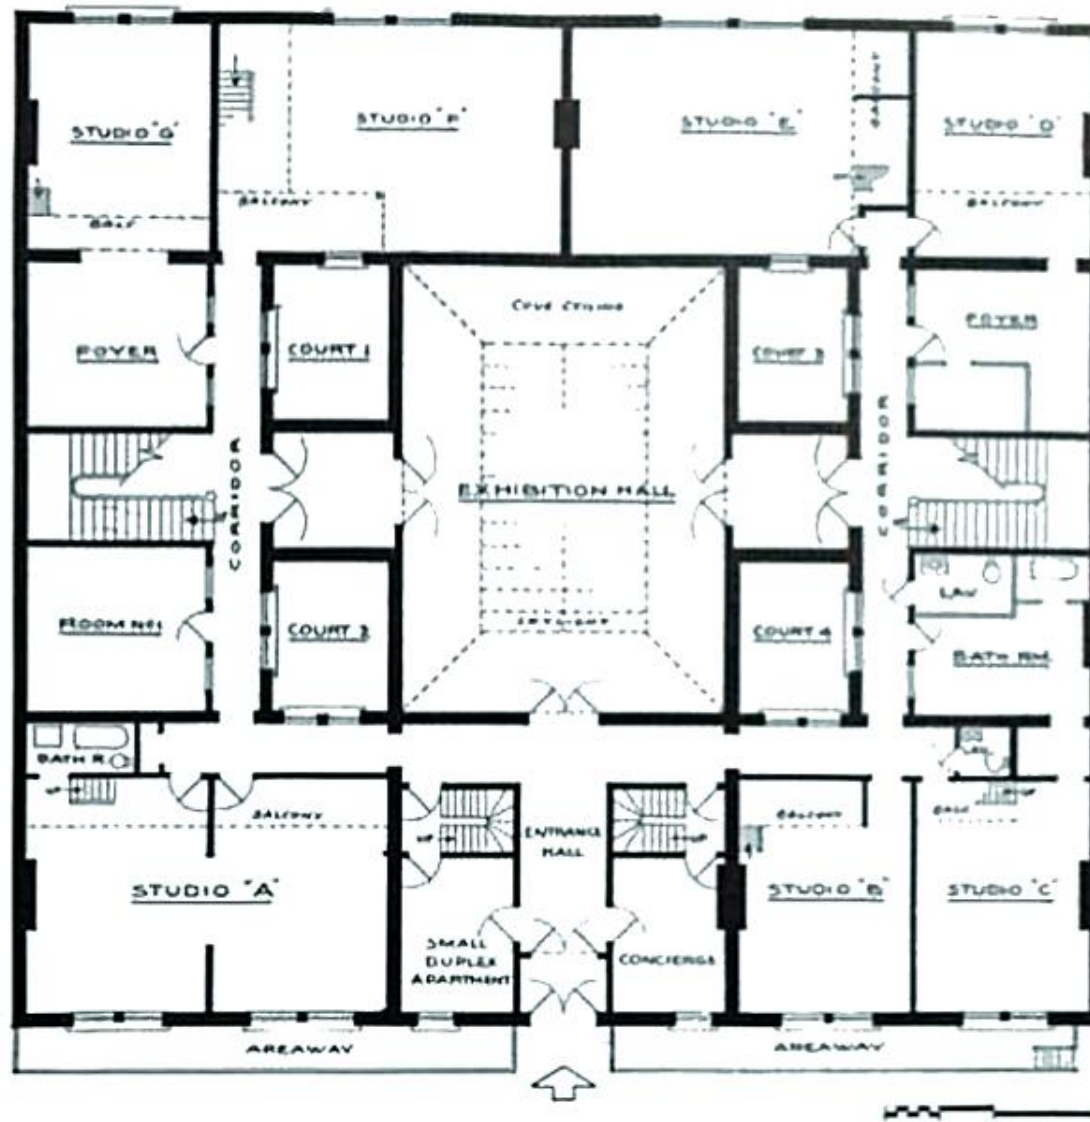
Plano de planta tipo del Tenth Street Studio. Fuente: <https://www.villagepreservation.org/2019/08/06/how-one-building-turned-greenwich-village-into-an-artists-mecca/>
